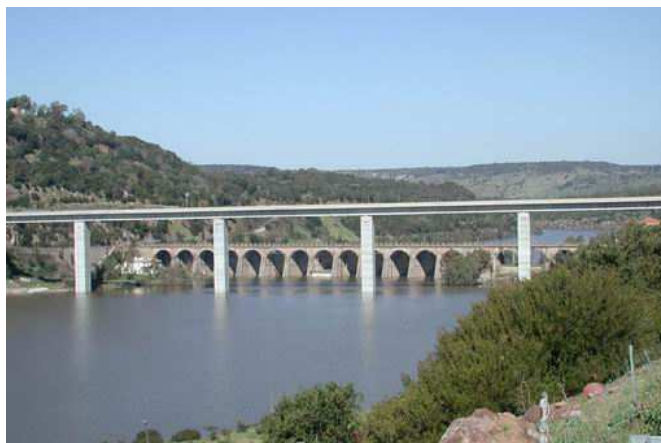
Vista della diga parzialmente sommersa: in primo piano il nuovo ponte stradale che collega le due sponde del lago Omodeo
